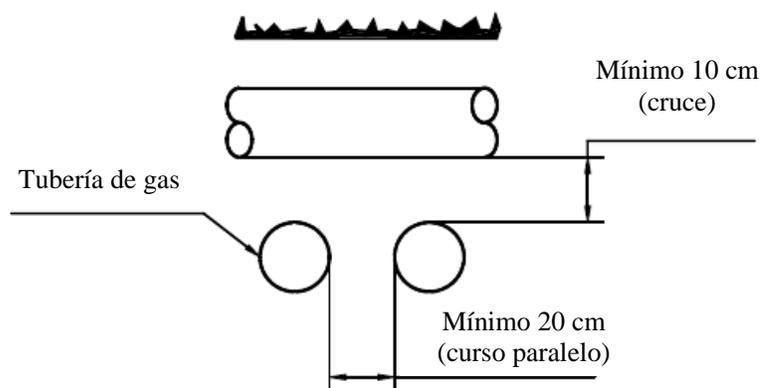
Distancias mínimas entre tuberías que conducen gas cuando se instalan enterradas y tuberías de otros servicios
